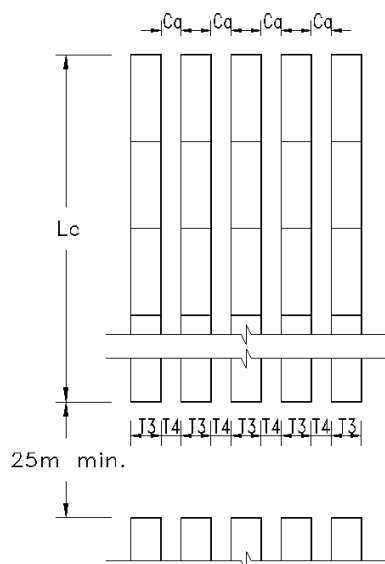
Área T.3 Sistema de Carretillas - Pórtico
